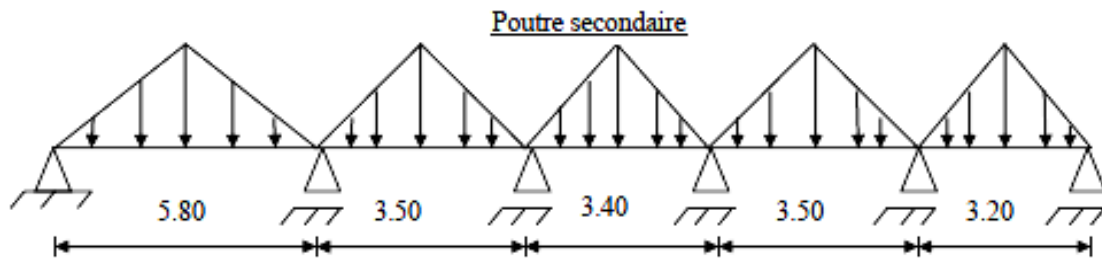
Distribution des charges sur les poutres secondaires.
